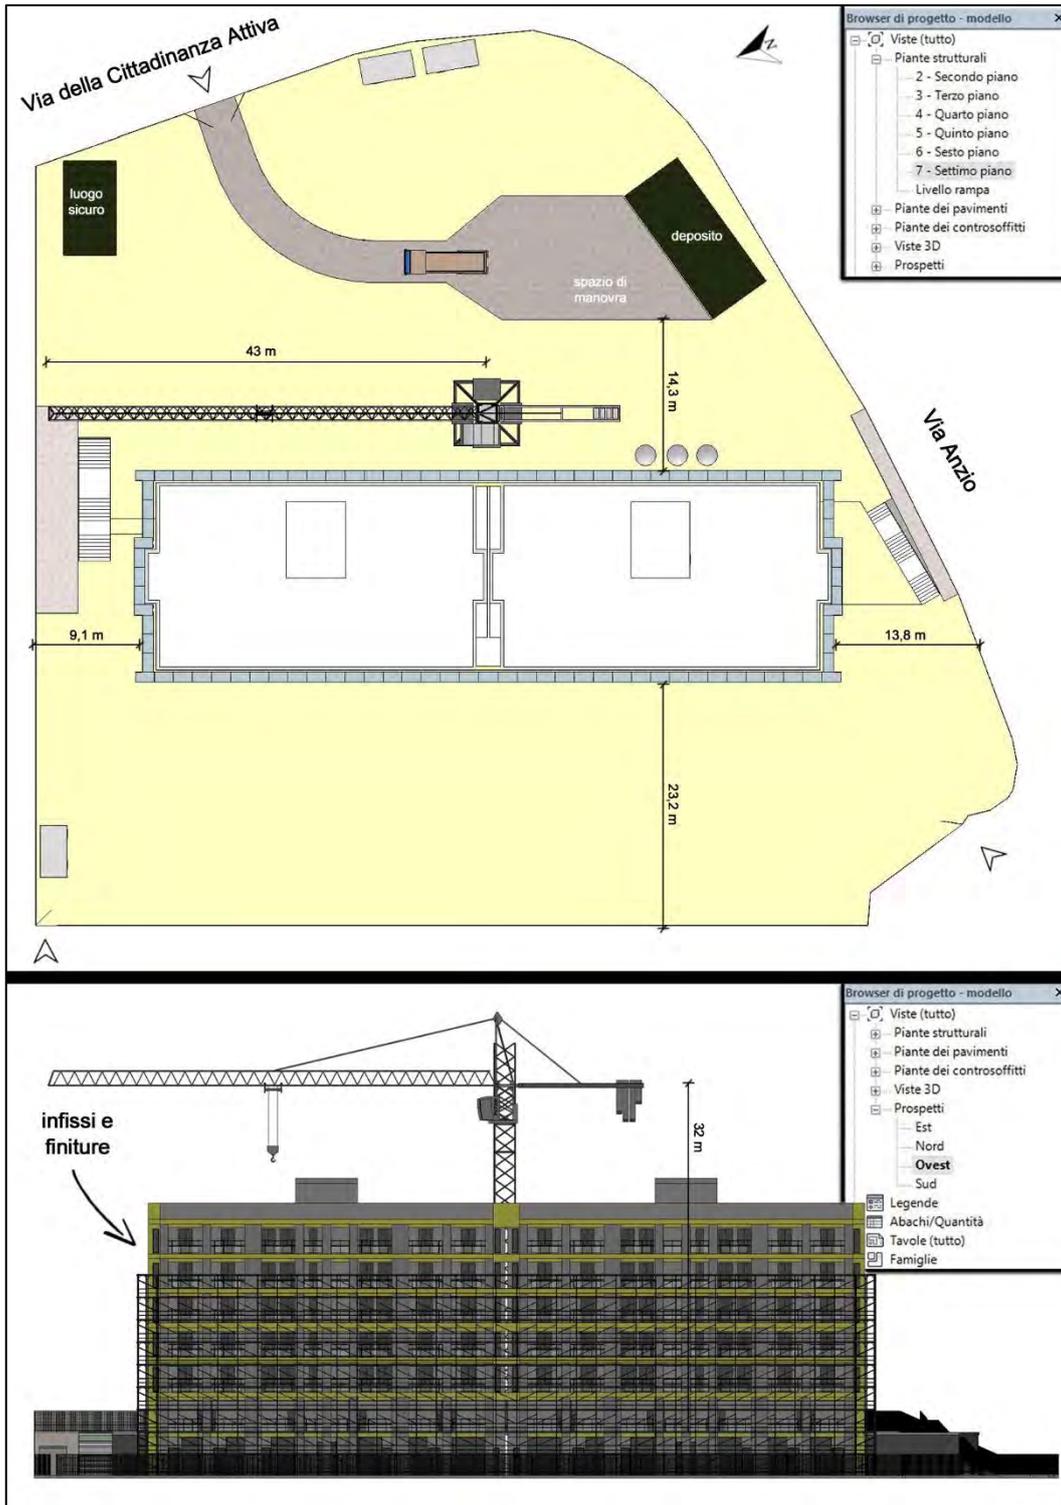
Planimetria e prospetto della fase di smontaggio del ponteggio
